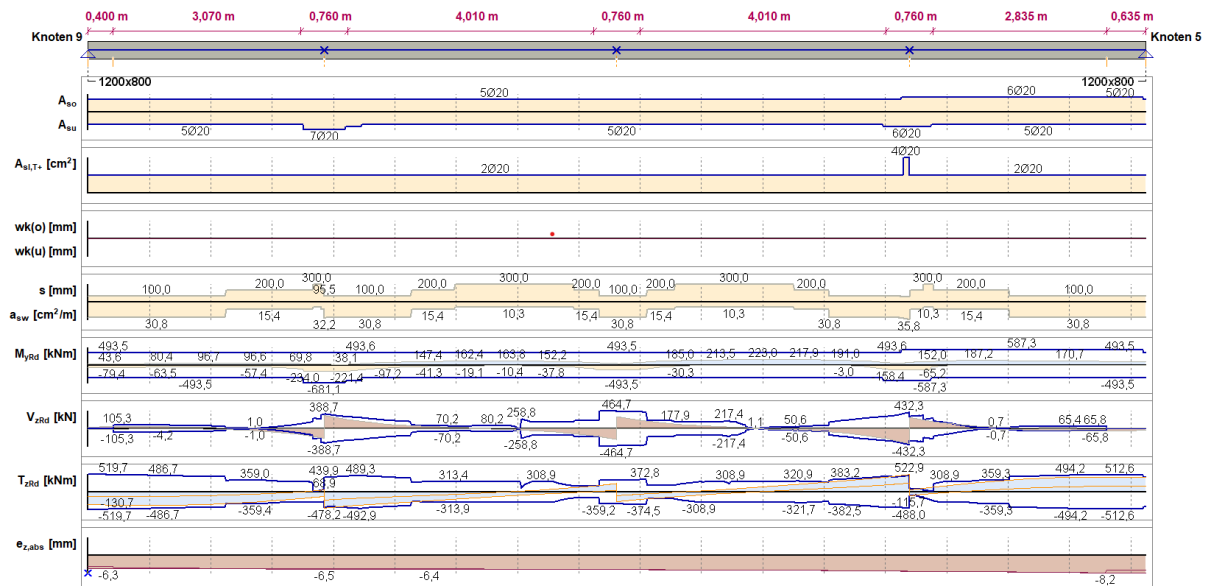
Berechnete Balkenbewehrung, Achse 1, vertikale Ebene
